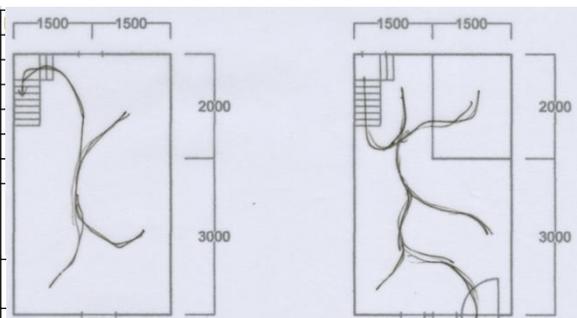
Denah lantai 1 rumah mbak Edh
